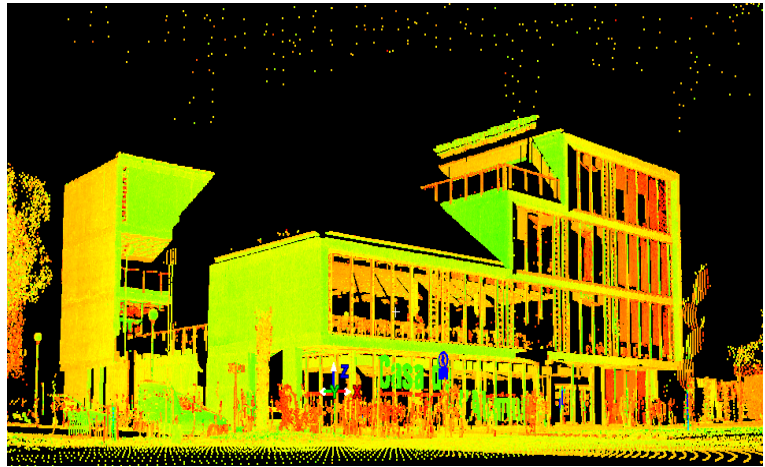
Captura de las fachadas de "La casa del Alumno".
